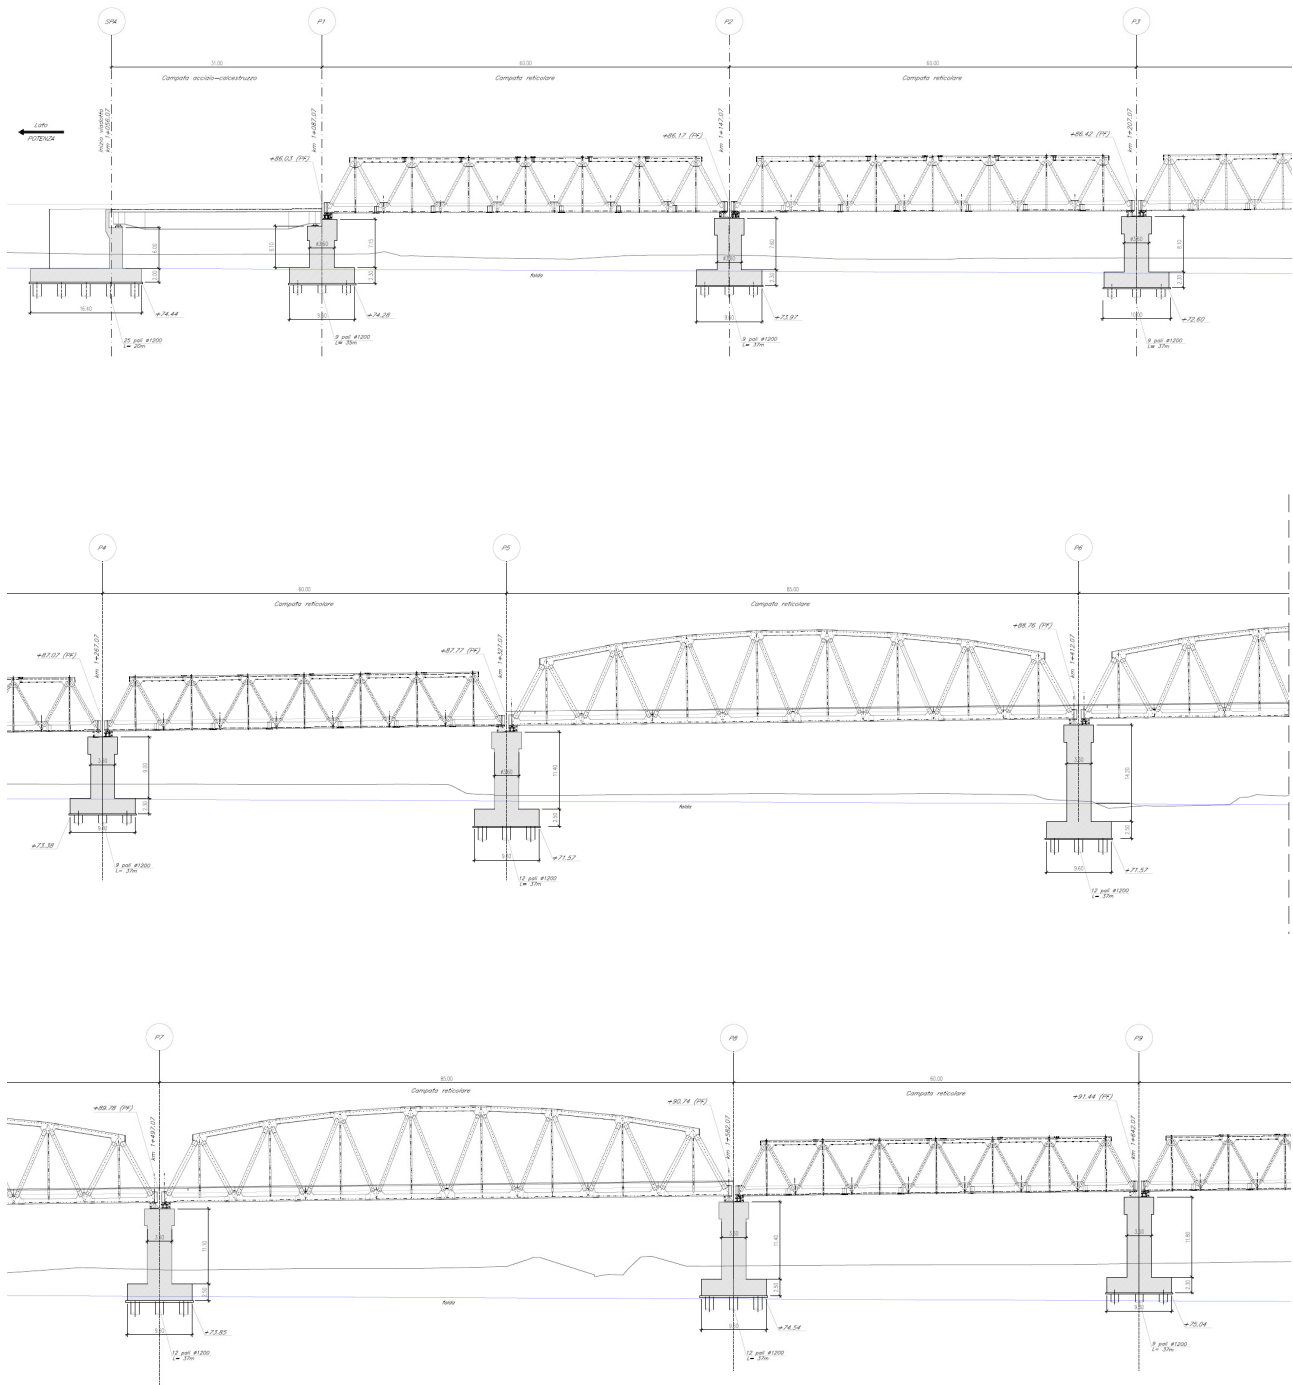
Sezione longitudinale viadotto VI13 Nuovo Basento
